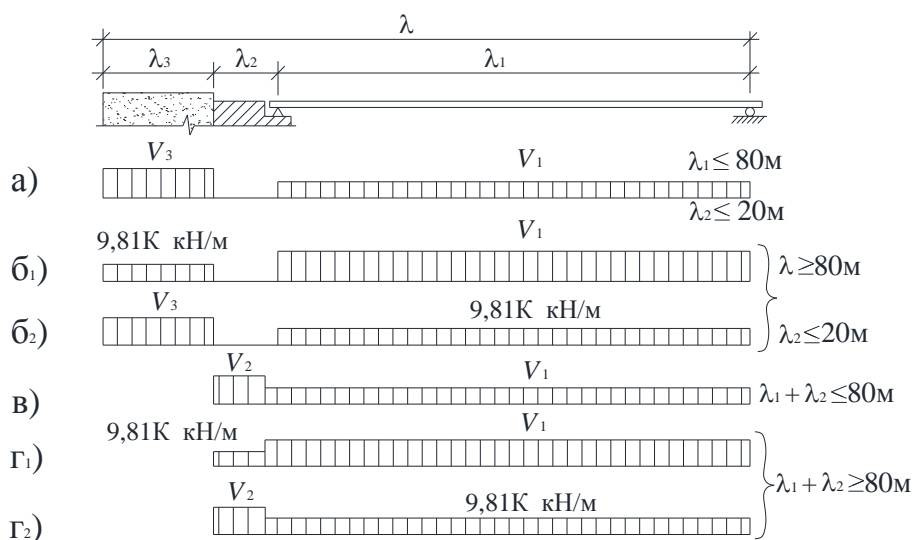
Схема загрузки пролета одновременно с призмой обрушения или пролета с устоем при расчете массивных устоев мостов с разрезными балочными пролетными строениями
